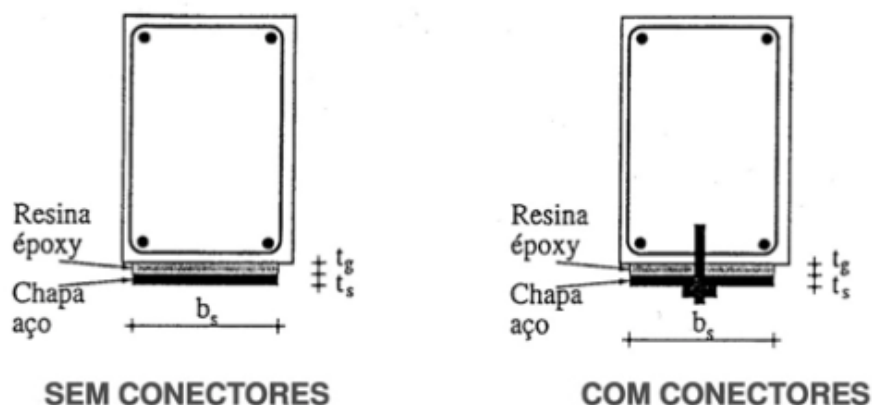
Desenho esquemático de reforço estrutural utilizando colagem [15]
